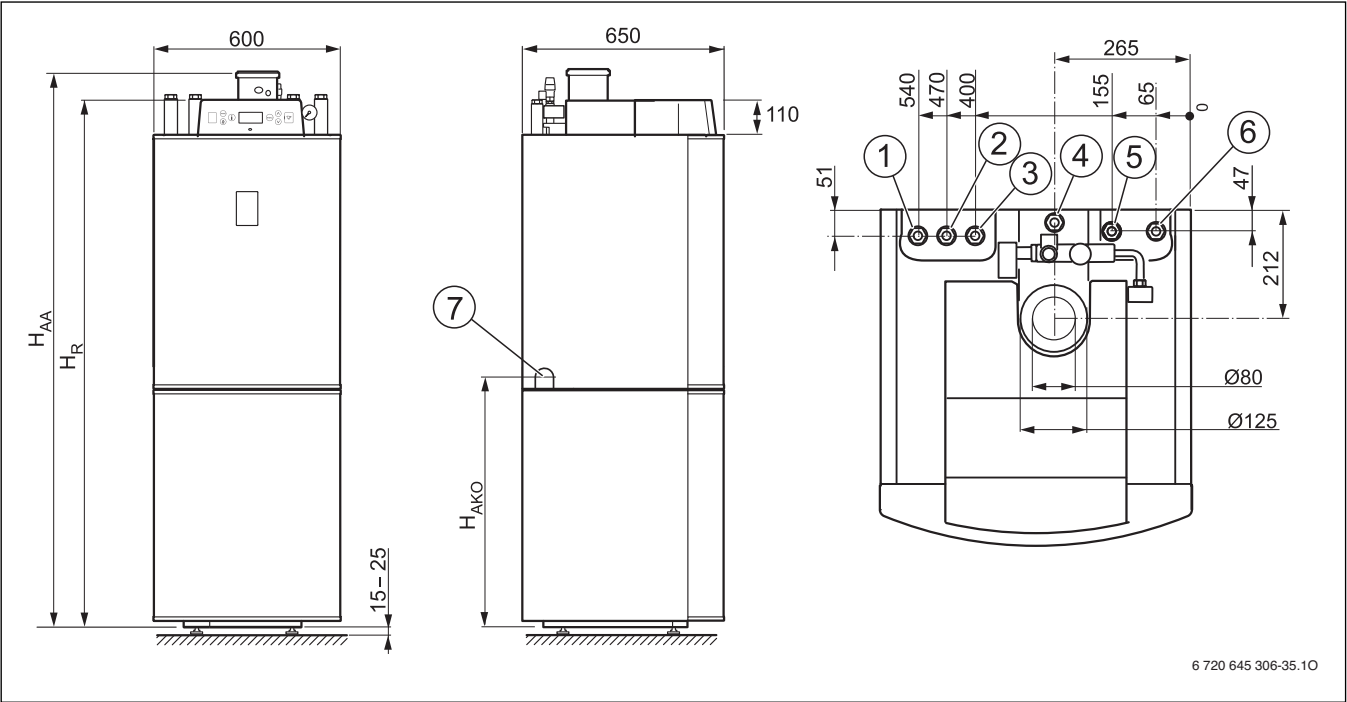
Anschlüsse und Abmessungen des Heizkessels mit optional eingebautem Warmwasserspeicher (Maße in mm)
